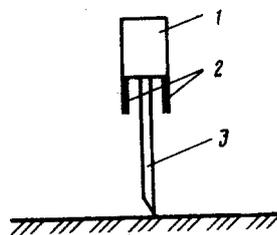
Специальное приспособление для забивки кольев: 1 - ударная головка; 2 - ручки; 3 - кол
